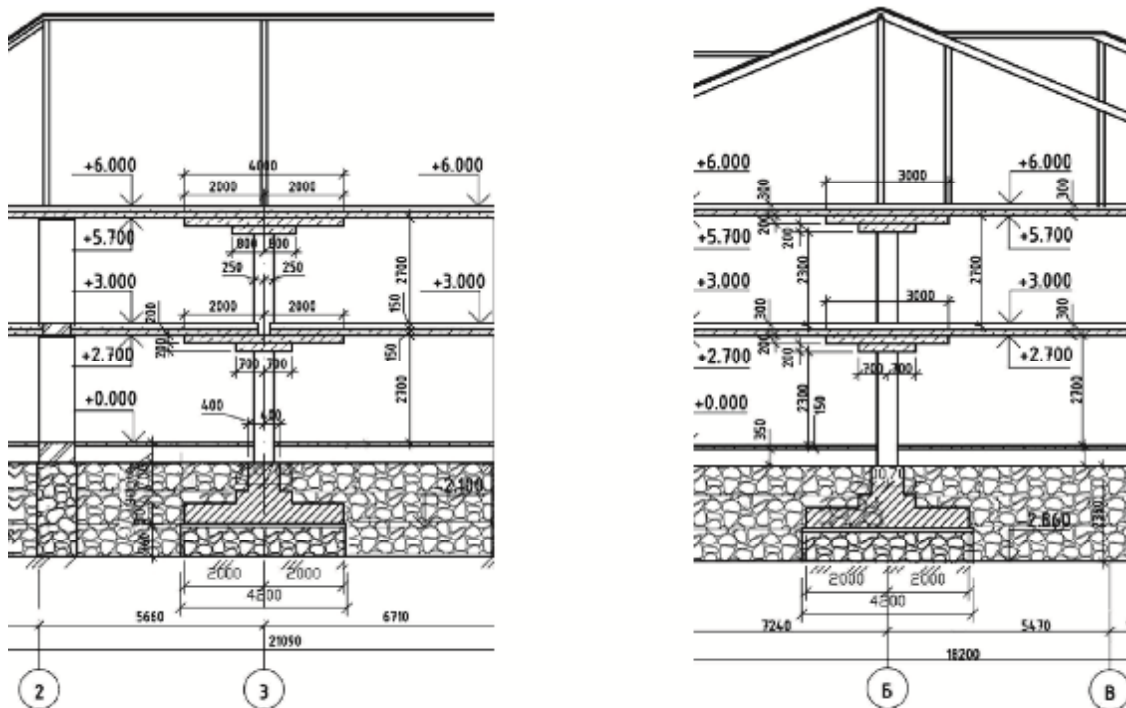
Разрезы по конструкциям центральной колонны на столбчатом фундаменте (иллюстрация авторов)
